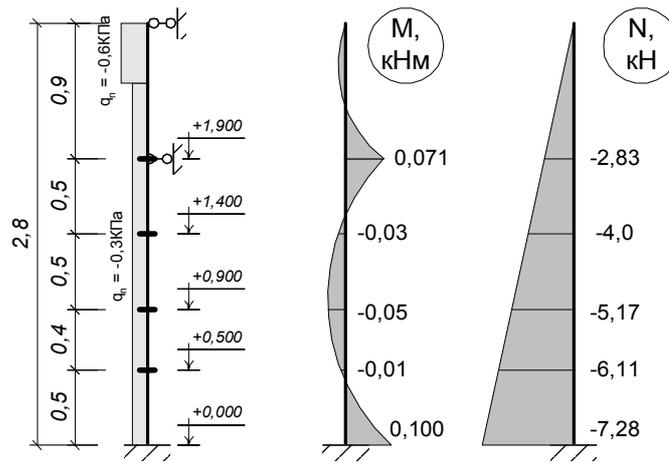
Расчетная схема кирпичной стены, эпюры изгибающих моментов и продольных усилий от ветровой нагрузки (ветер справа) и собственного веса
